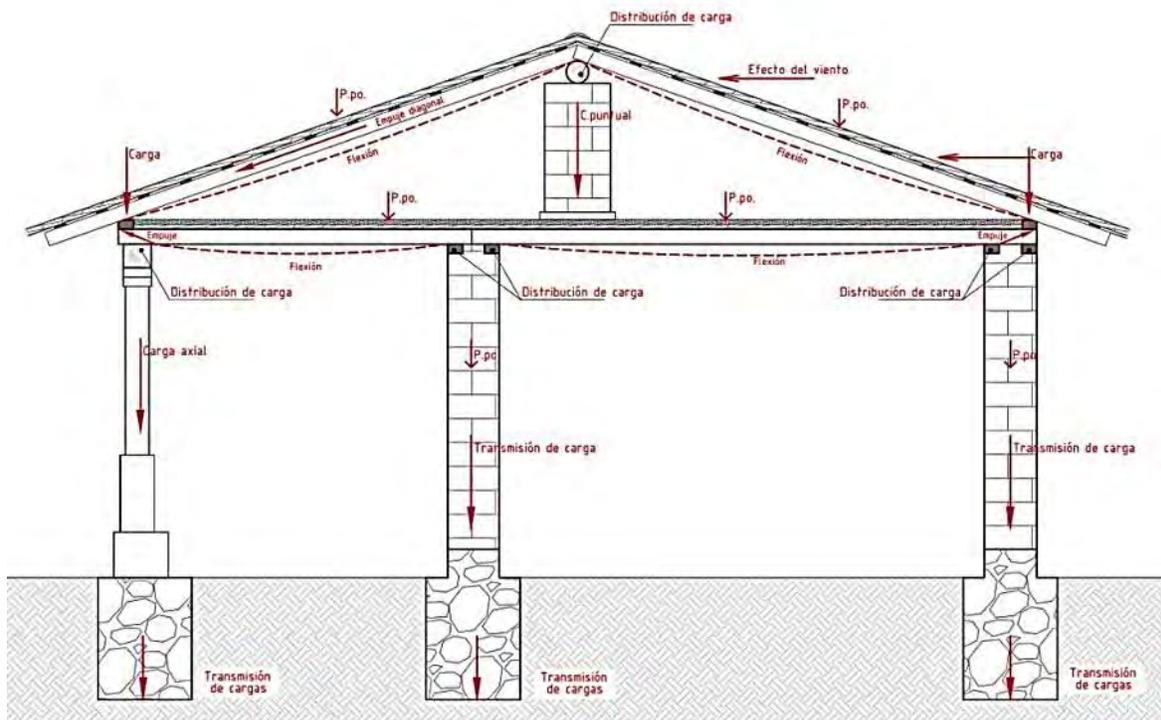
Esquema general de distribución de cargas en cubierta del sistema tradicional. En este se observa cómo los diferentes componentes de la estructura están sometidos a distintos esfuerzos, y trabajan para generar el equilibrio estructural. Elaboró: AMT.
